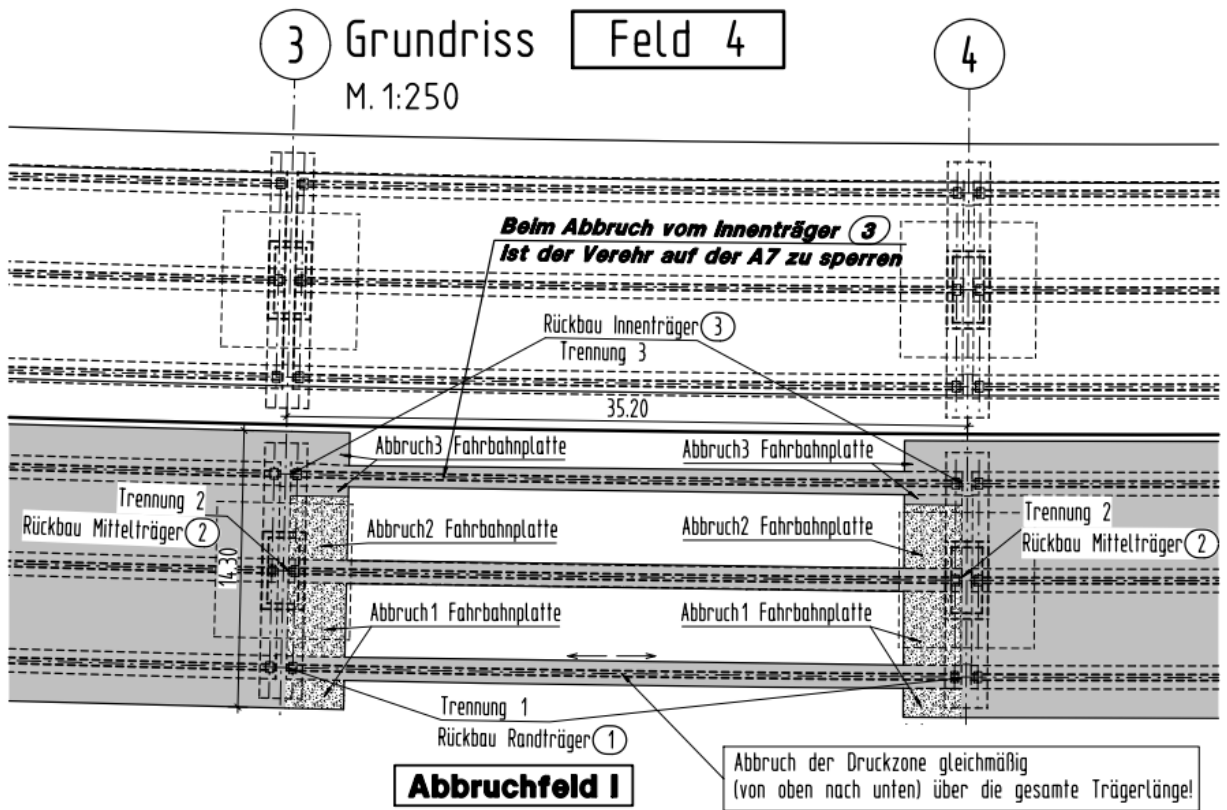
Abbruchfeld I (© Adam Hörnig Baugesellschaft mbH & Co. KG)
